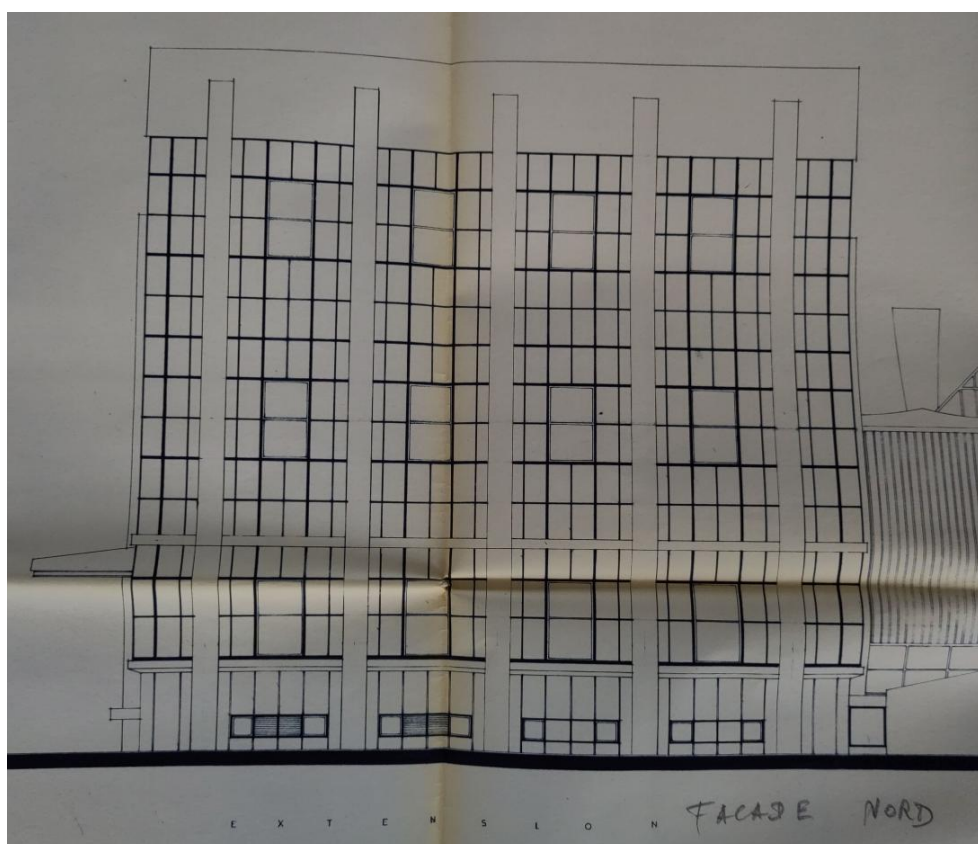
Plan de façade - Permis P. Fayolle 1964
